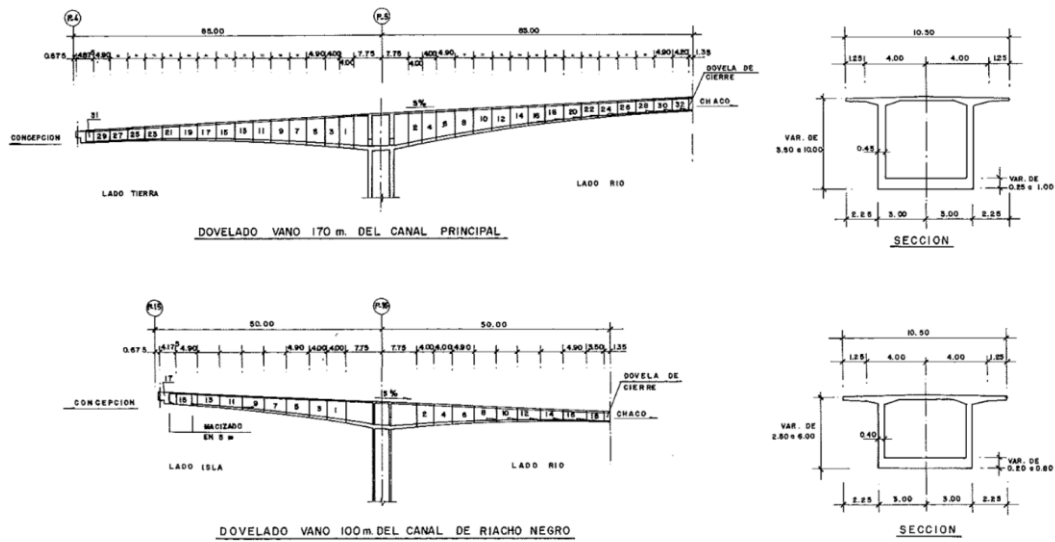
Puente Concepción Pto. Militar, secciones utilizadas (Fuente: [25]).
